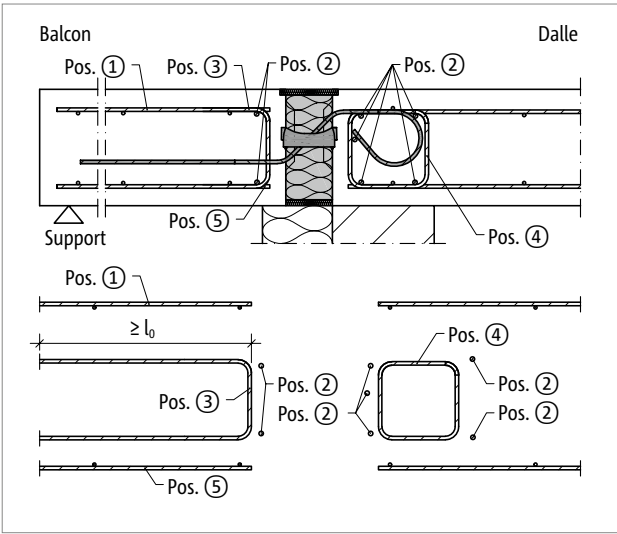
Schöck Isokorb® T Type Q-E-W-V : Renforcement sur site
